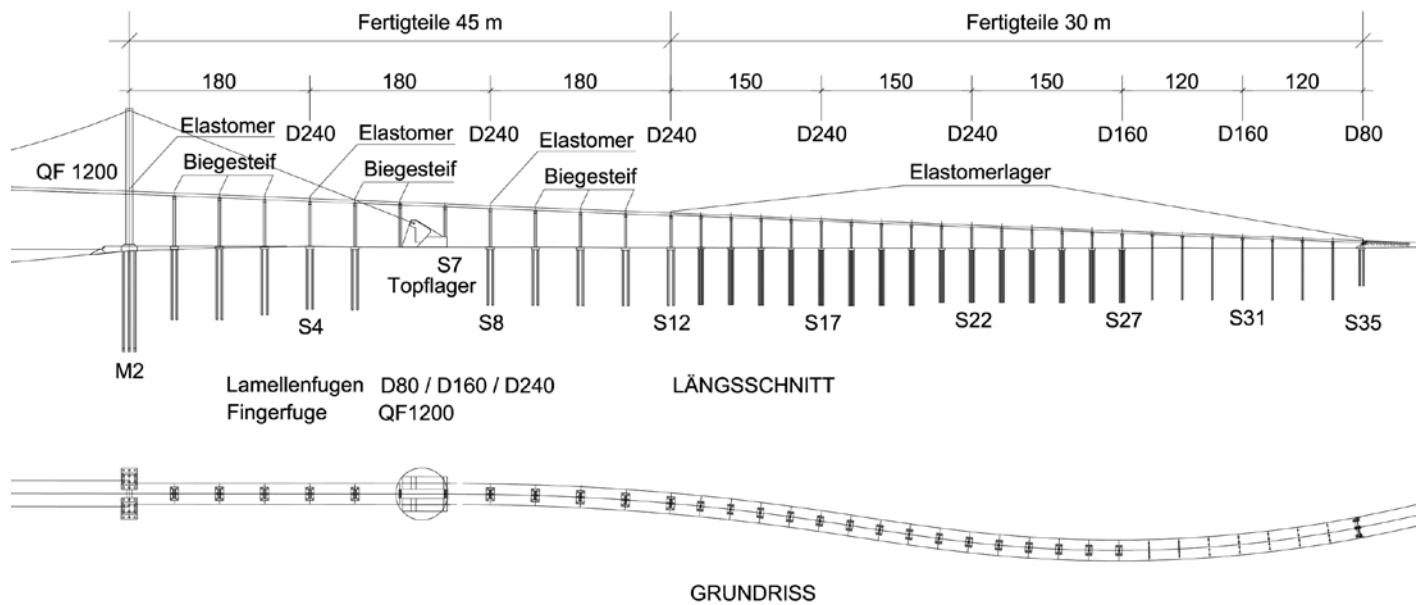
Grundriss und Längsschnitt der südlichen Vorlandbrücke mit Details
